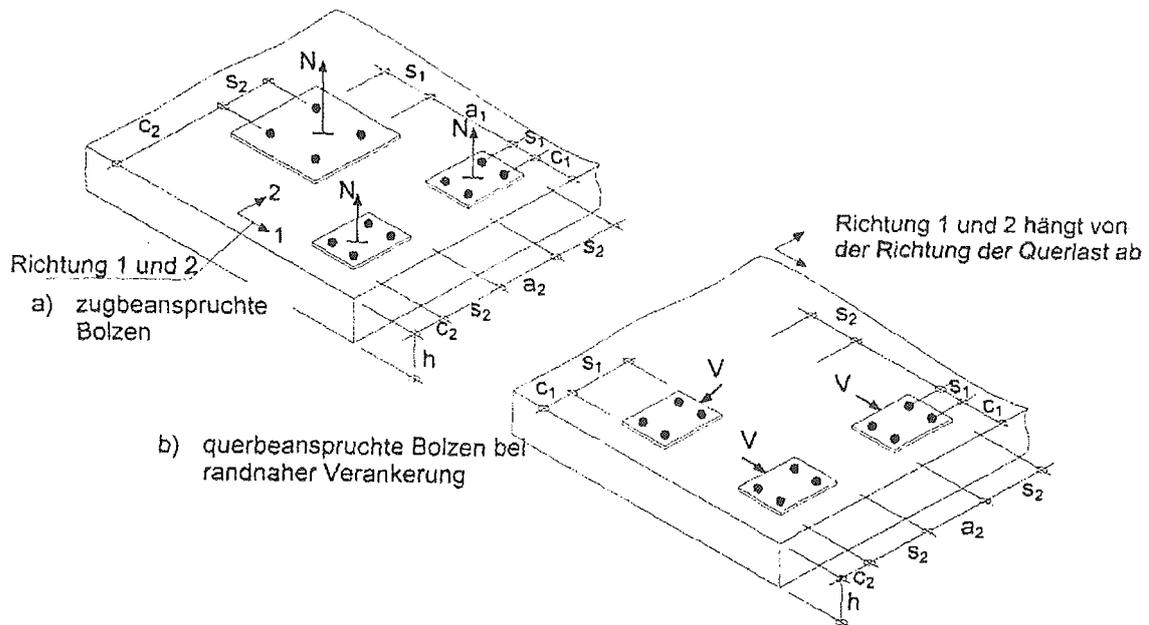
Betonbauteil, Ankerbolzenachs- und randabstände
